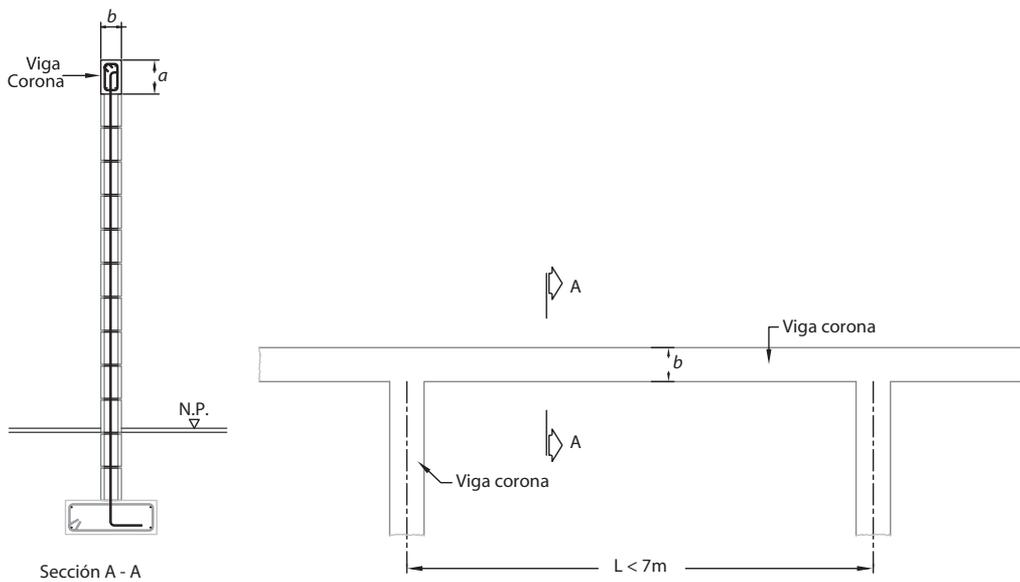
Detalle de viga corona para rigidizar paredes.
